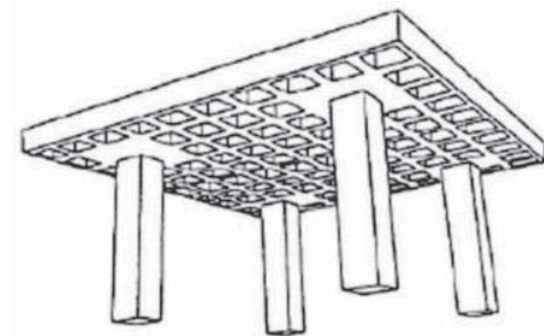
Losa aligerada con casetones. Cálculo de losas postensadas, Tesina de Especialidad. Pág. 18.
